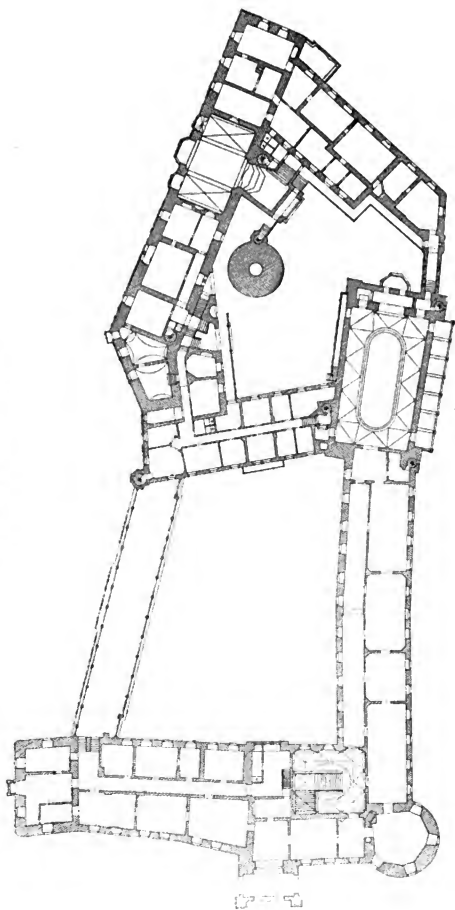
Grundriss der Burg Zbiroh.
